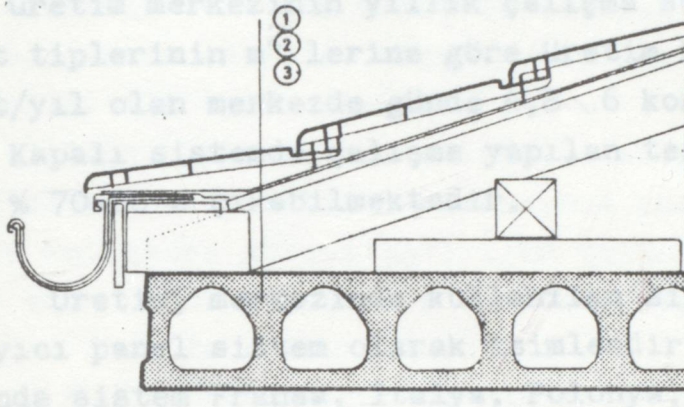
Boşluklu döşeme elemanı ile duvar uygulaması detayı.
